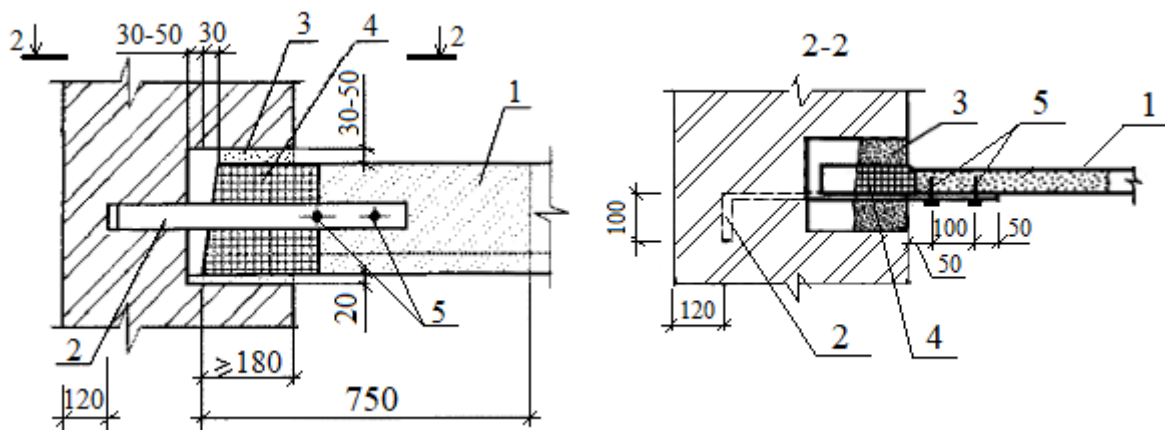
Узел опирания деревянной балки перекрытия на наружную несущую стену из кирпича
